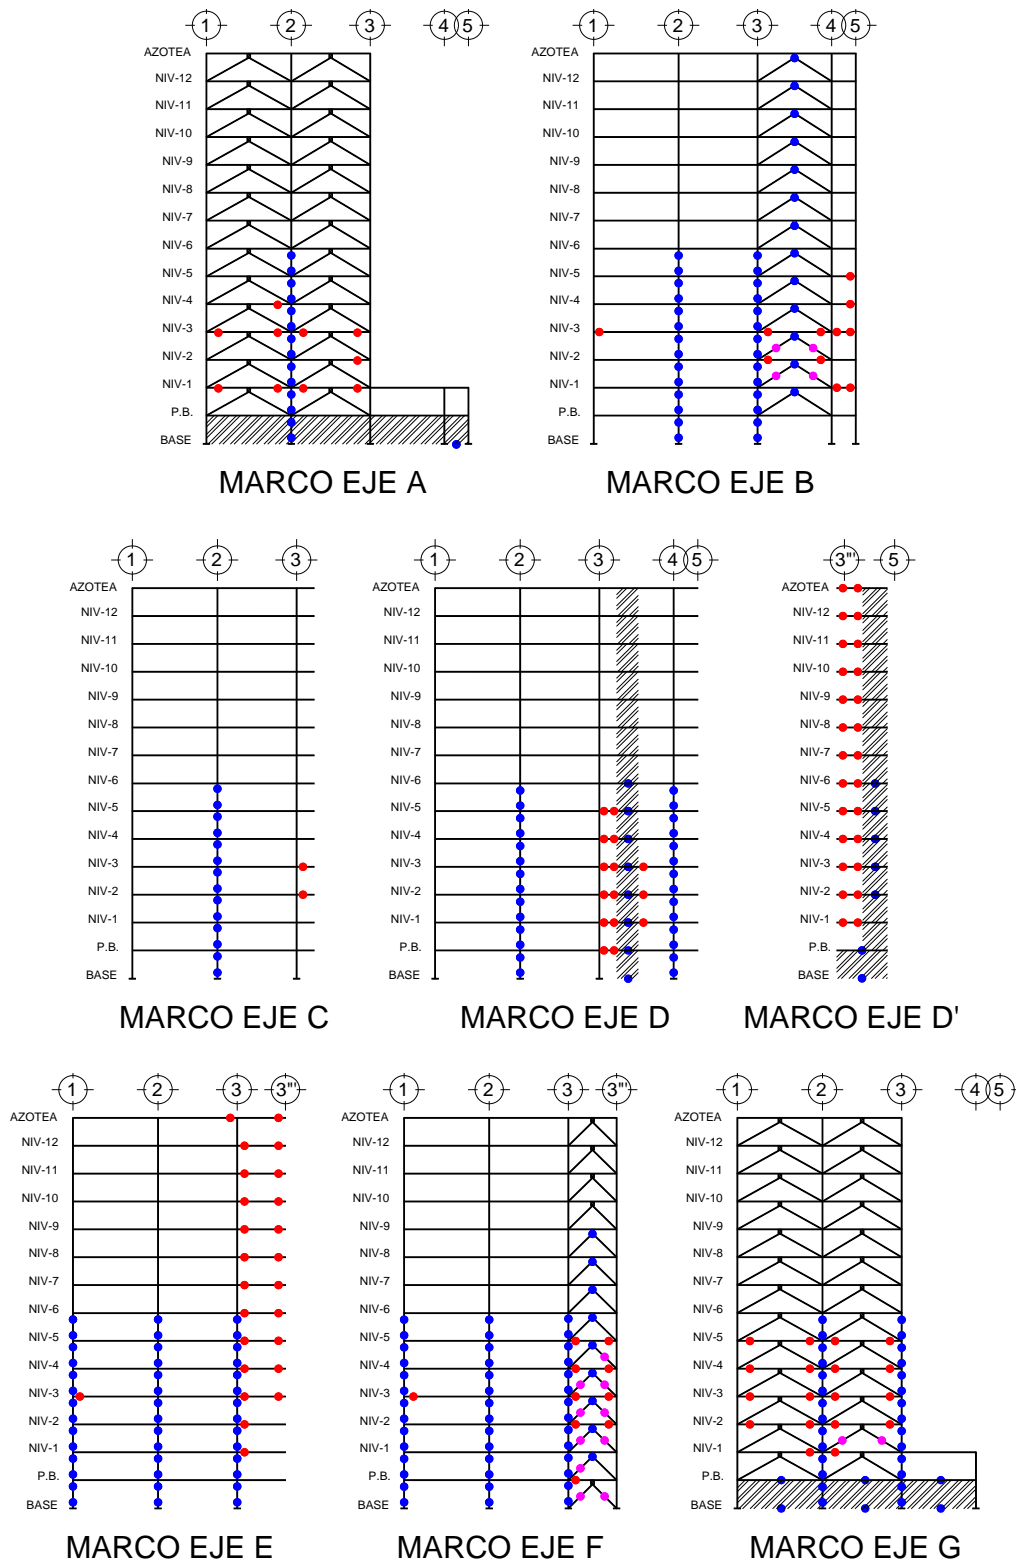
Articulaciones plásticas en la estructura, marcos transversales.
